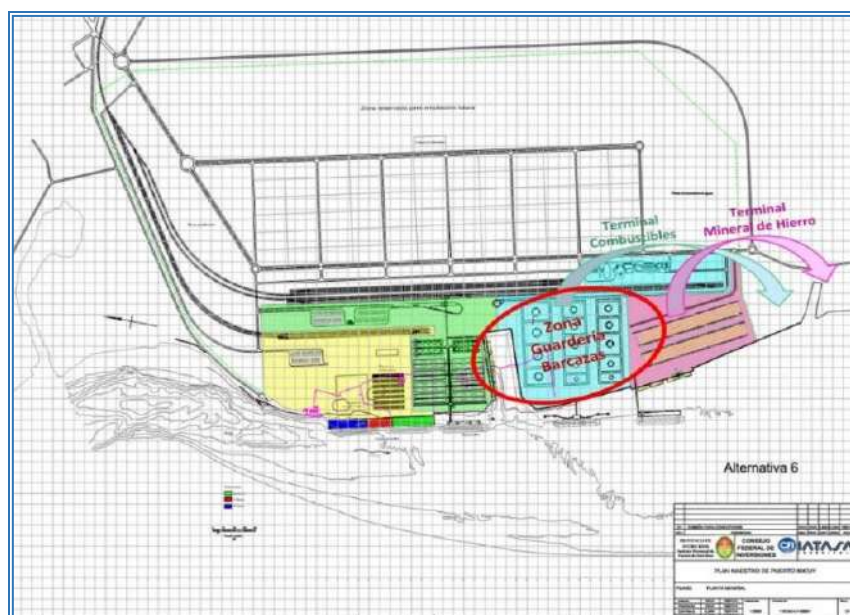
Plan Maestro Puerto Ibicuy, Plano Alternativa 6
